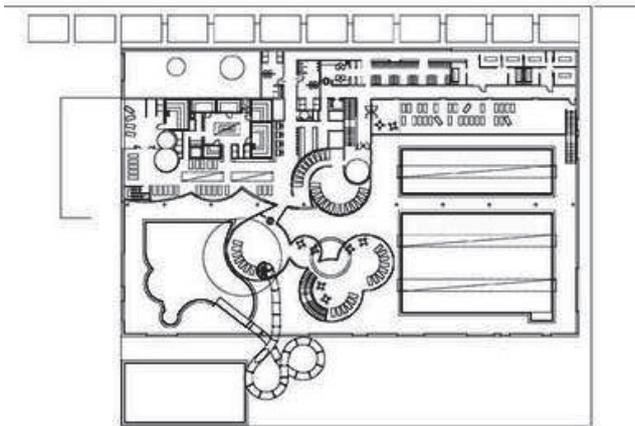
Grundriss Ebene 10 - Drautalperle
